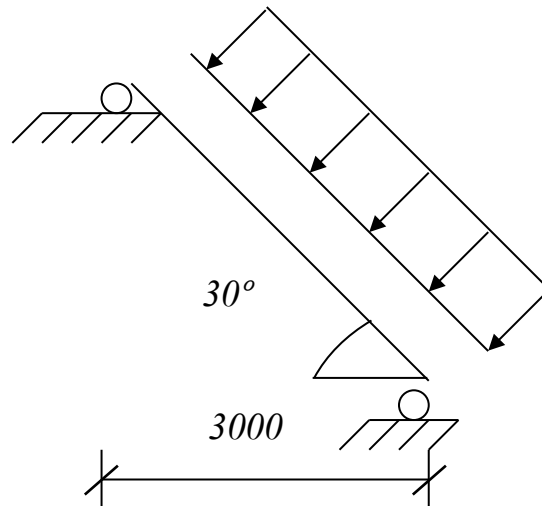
Геометрична схема до розрахунку сходового маршу
